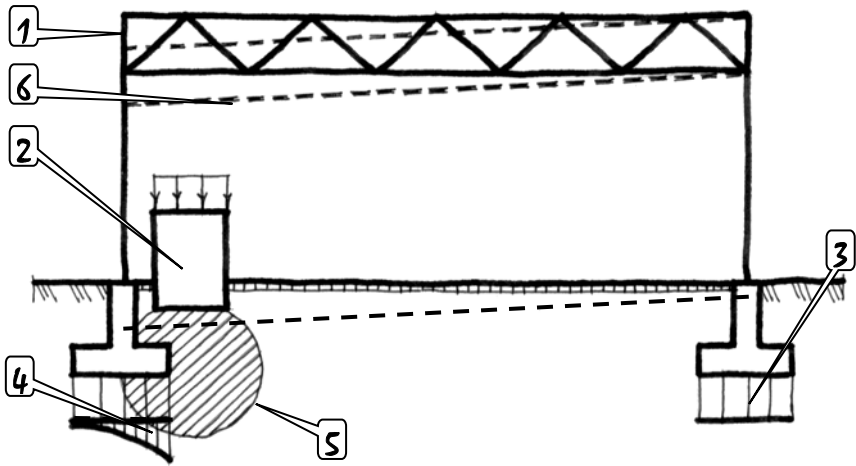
Деформації при влаштуванні фундаментів під важке обладнання: 1 – проектне положення будівлі; 2 – додаткове важке обладнання; 3, 4 – епюри осідань фундаментів до і після установки важкого обладнання; 5 – межа зони ущільненого ґрунту; 6 – положення будівлі після деформацій її несучих конструкцій
